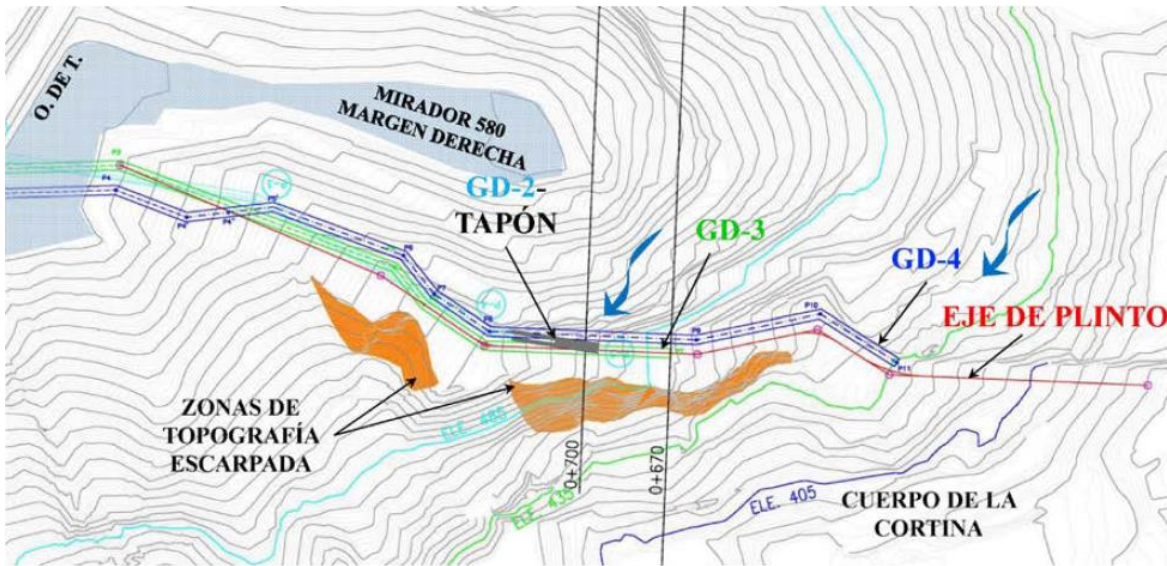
Planta topográfica y su relación con los tímpanos oriente galerías GD-2 y GD-3 (CFE,2013).
